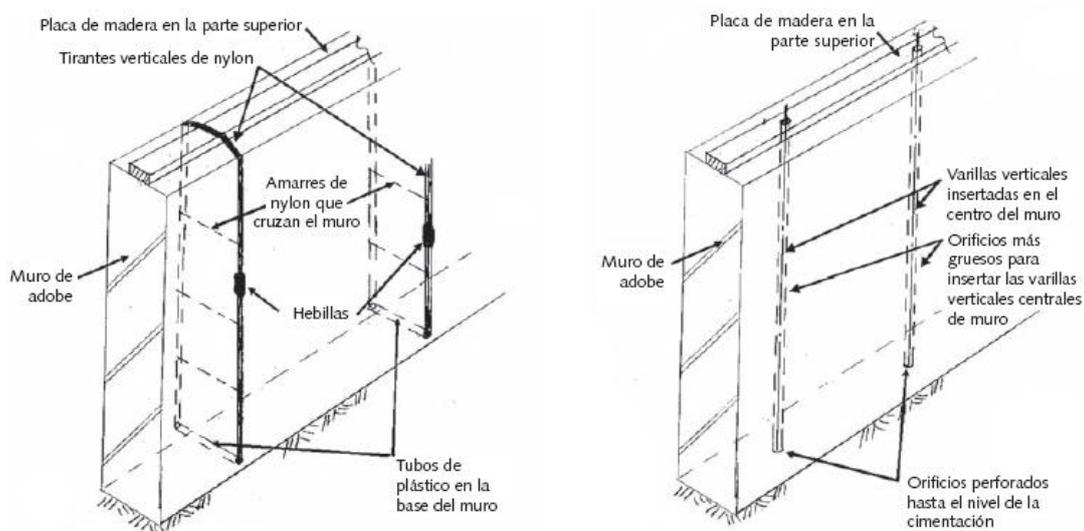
Izquierda: Refuerzo con tirantes y amarres que atraviesan un muro de adobe. Derecha: Refuerzo con varillas verticales insertadas en el centro de un muro de adobe.
